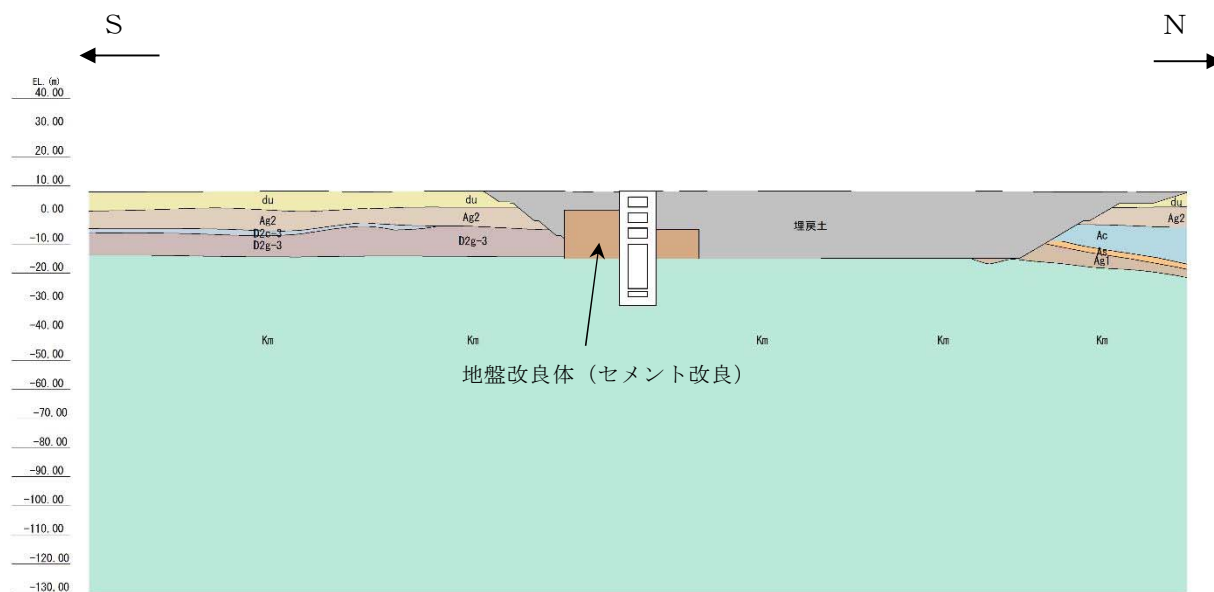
(1) 立坑の評価対象断面図 (南北方向断面)
